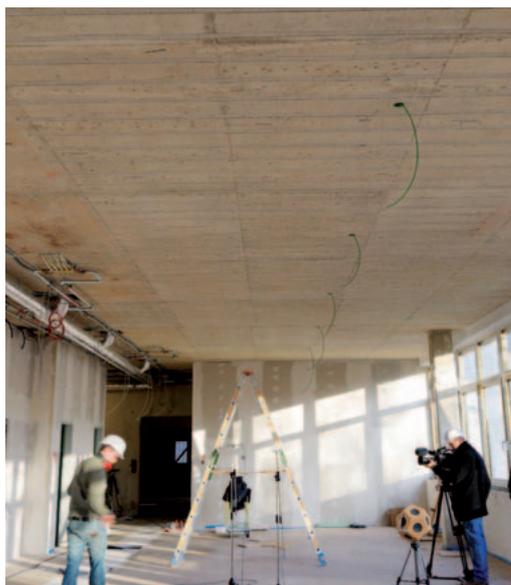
Betondecke mit Bauteilaktivierung und integrierten Schallabsorbern aus Glasschaum
